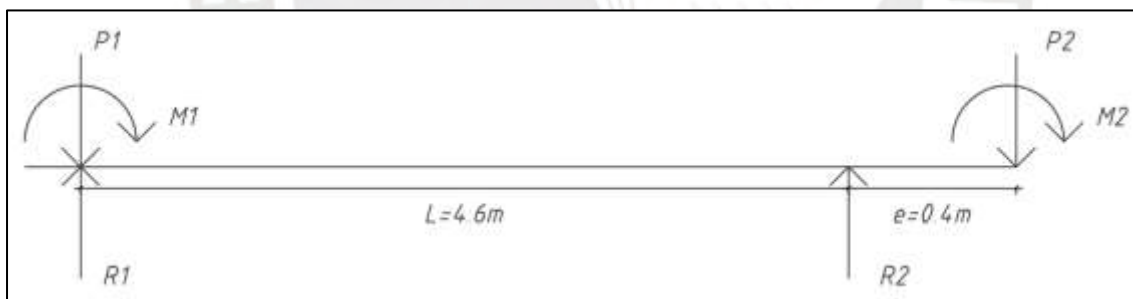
Modelo de fuerzas simplificado de las zapatas conectadas
